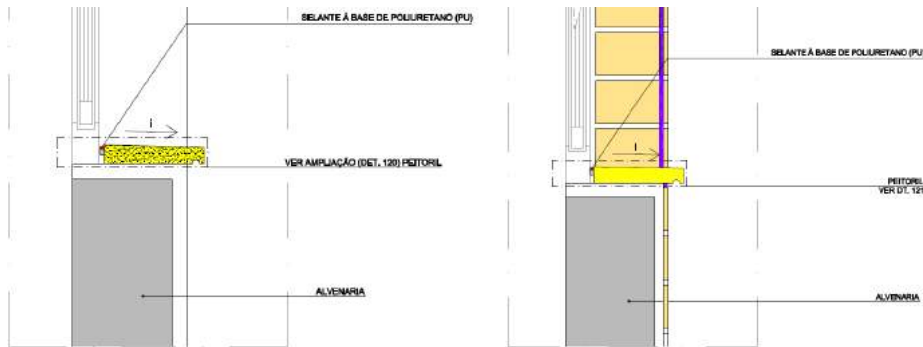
Elemento de EPS na fachada – Projeto de Produção de fachada (R0)
